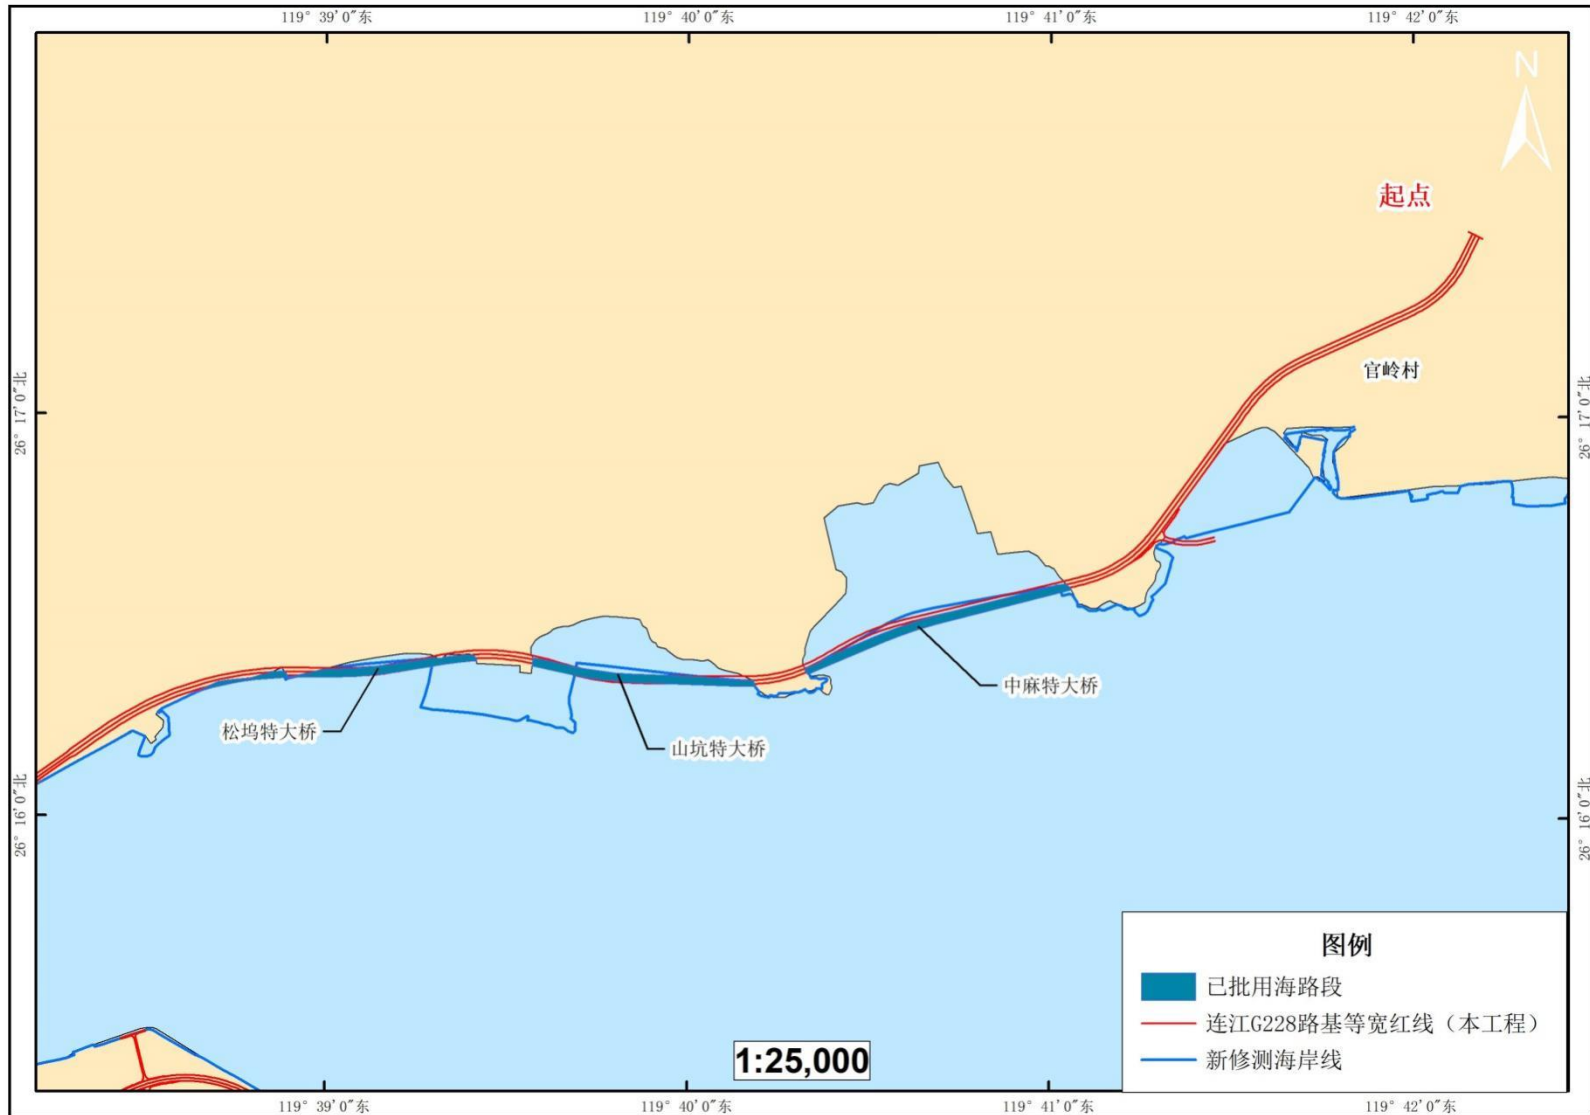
本工程涉海路段平面布置图 (分幅 1)
